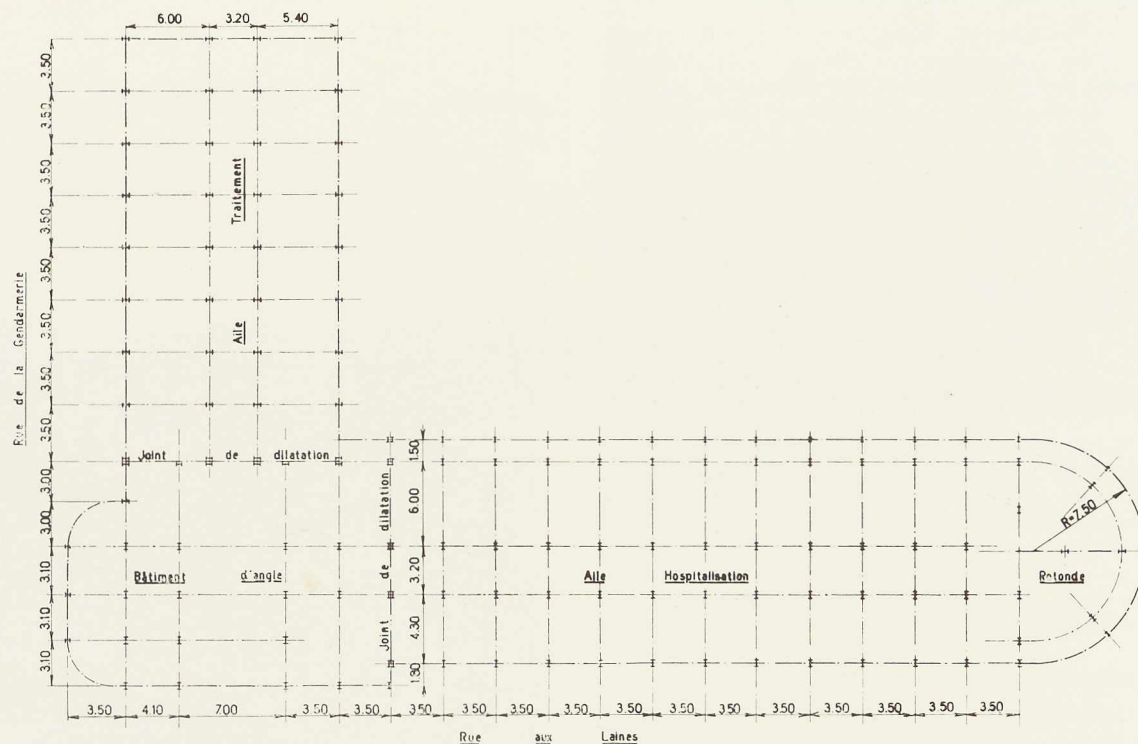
Plan du bâtiment au niveau du rez-de-chaussée.
